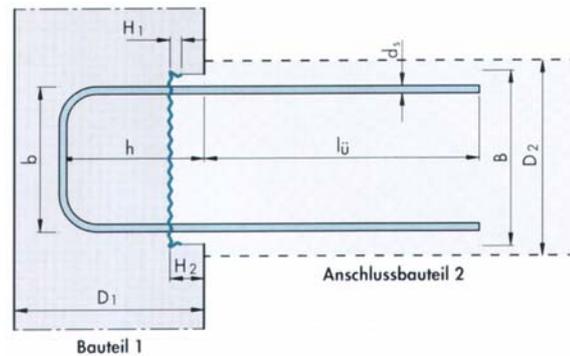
Bewehrungsrückbiegeanschluss als Deckenanschluss
